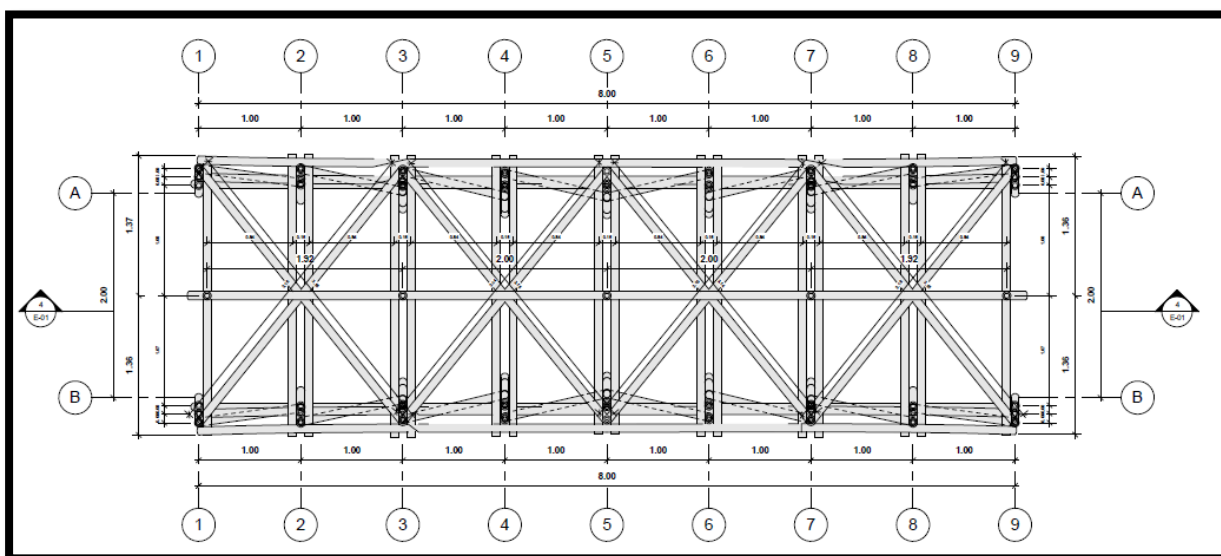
Plano Predimensionamiento - Vista Lateral con cotas
